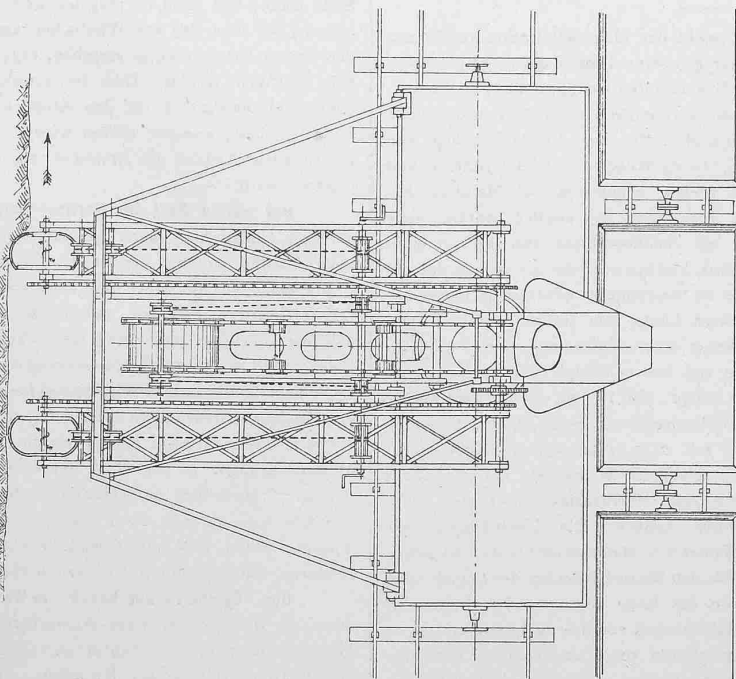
Bagger mit rotierenden Extraktoren, System Sonderegger. — Grundriss. — 1 : 100.
